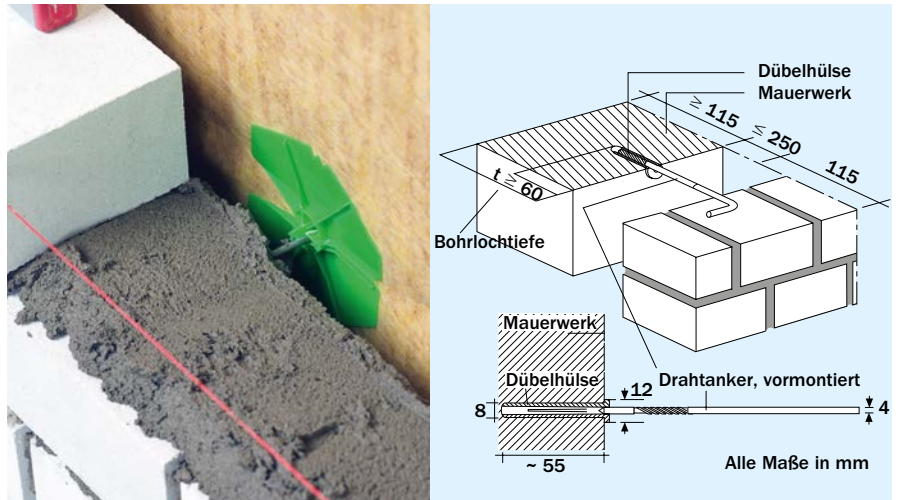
Dübelanker mit Klemmscheibe im eingebauten Zustand (links) und als Prinzipskizze (rechts)
